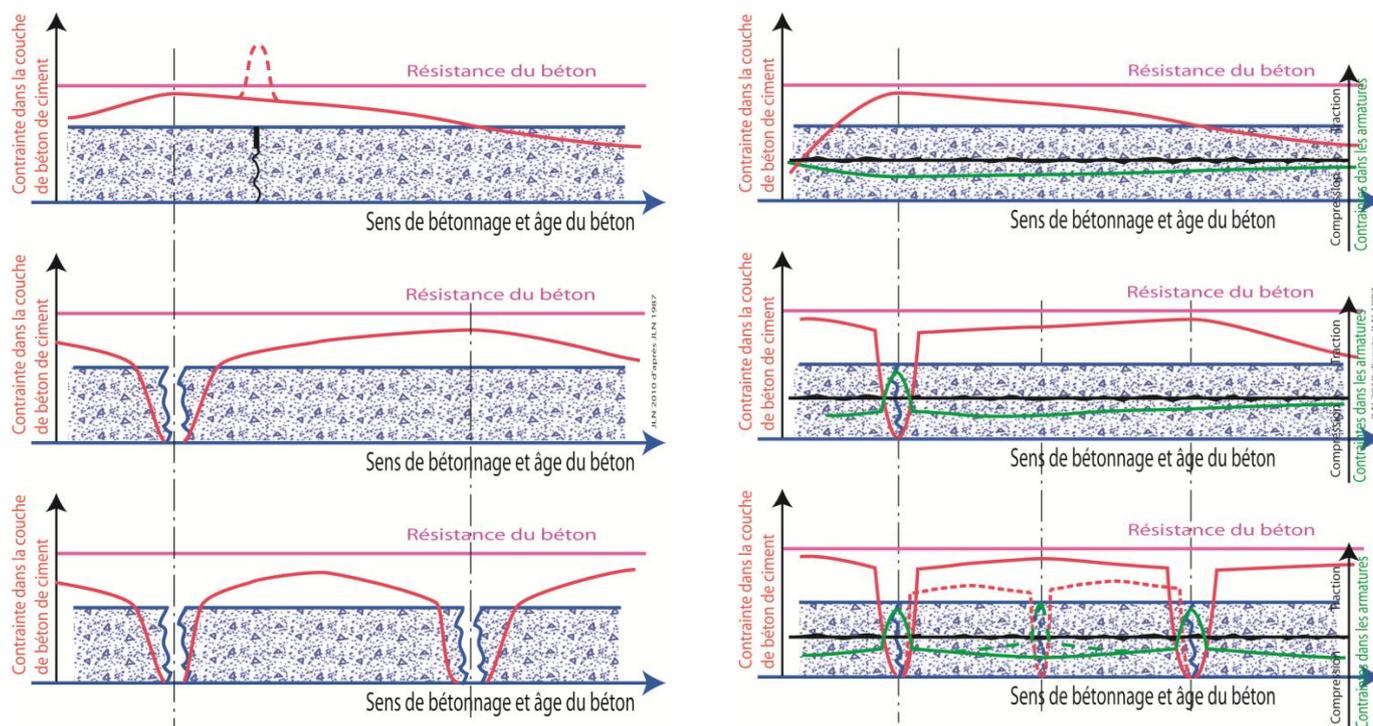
Fissuration d'un revêtement avec armatures longitudinales (à droite, à gauche rappel de la figure 8)
